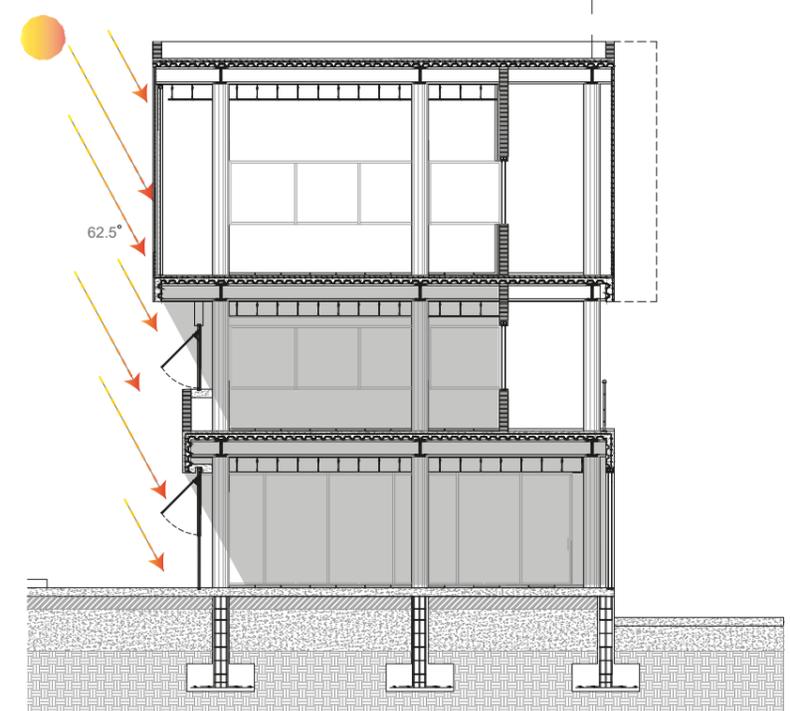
Análisis de protección muros de hormigón perforados fachada este- oeste
